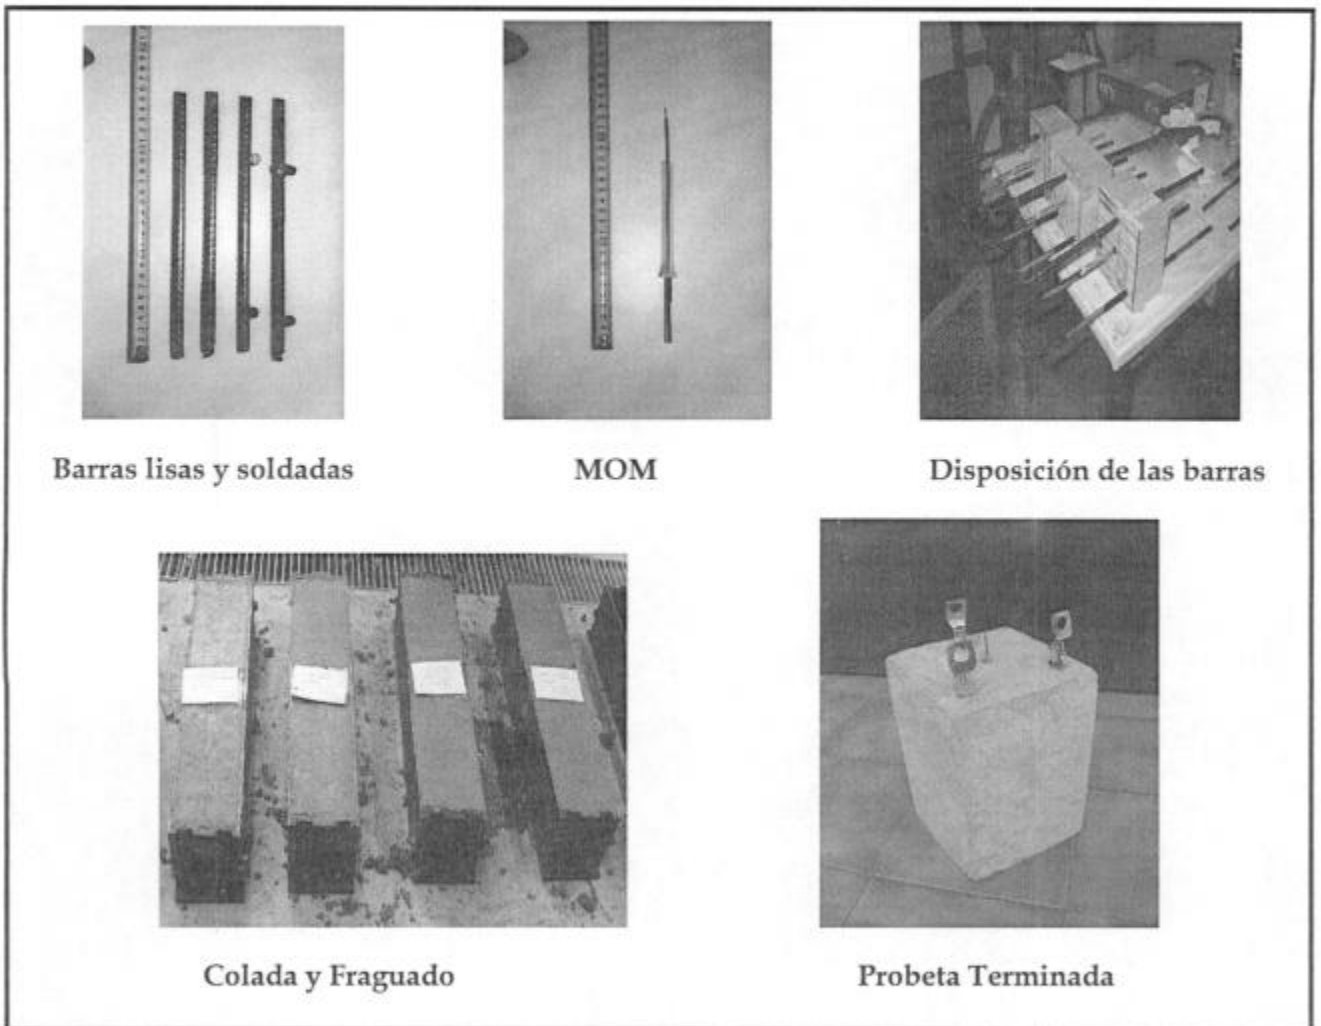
Pasos en la fabricación de las probetas de hormigón armado.
